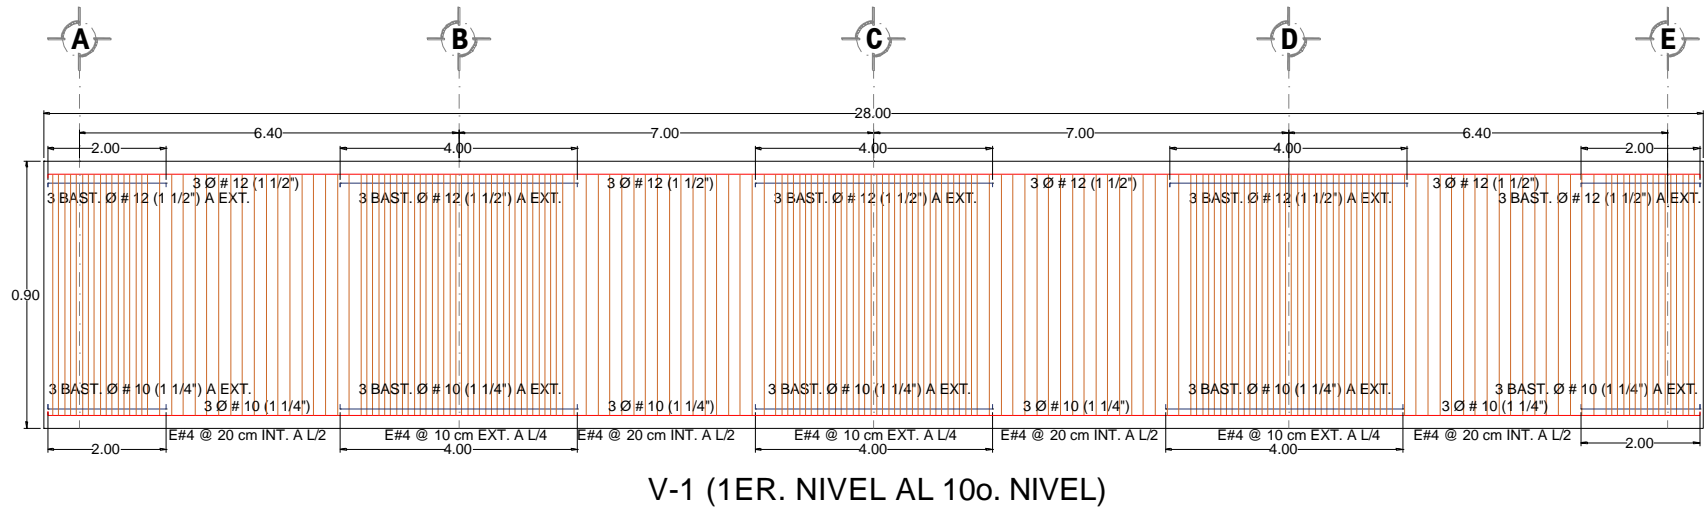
Detallado de armado de vigas del marco de 15 niveles con base a secciones gruesas.
